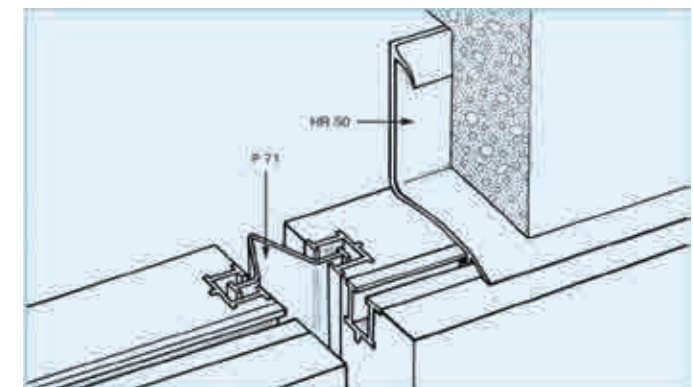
Perfil para junta conformada de la empresa ‘Couvraneuf’
